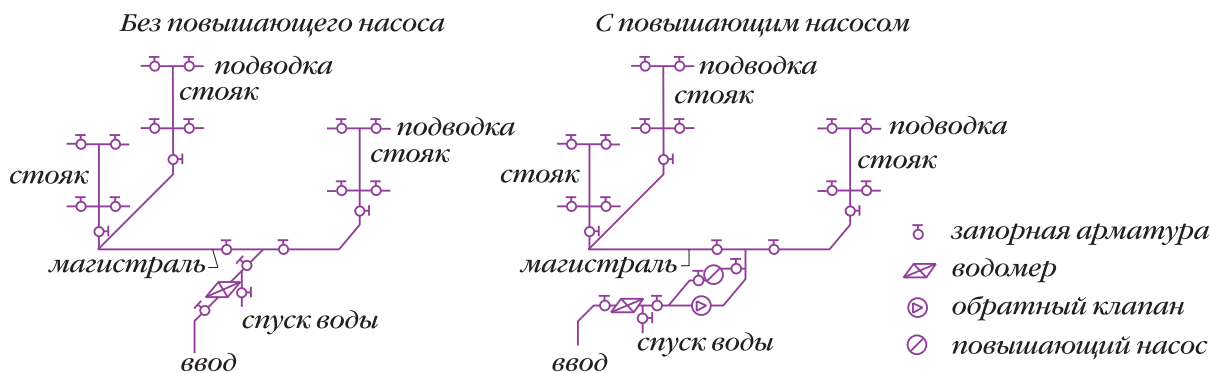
Схемы внутреннего водопровода (например, коттеджа)
